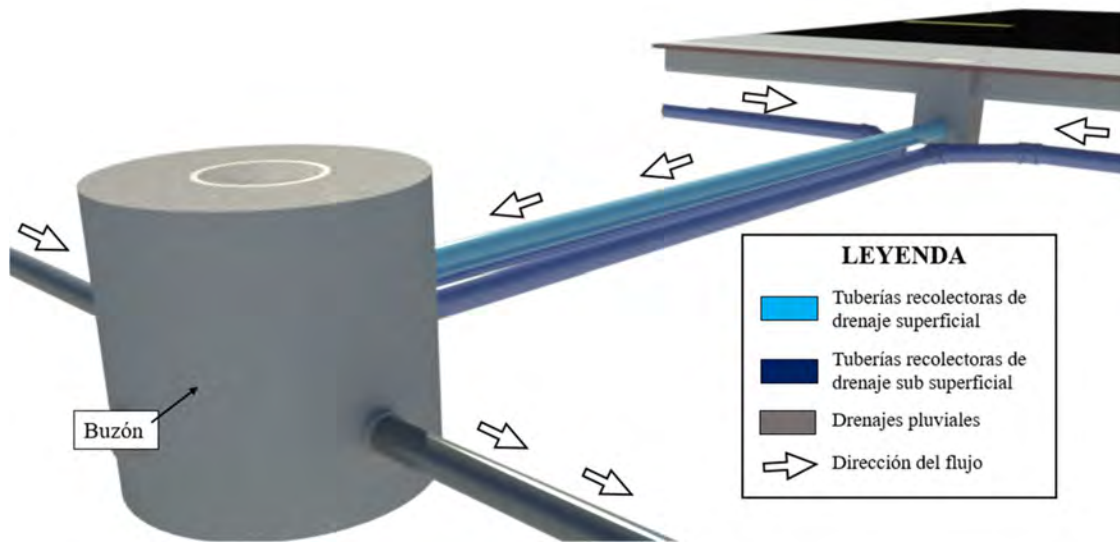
Detalle de descarga de caudales a la red de drenaje pluvial
